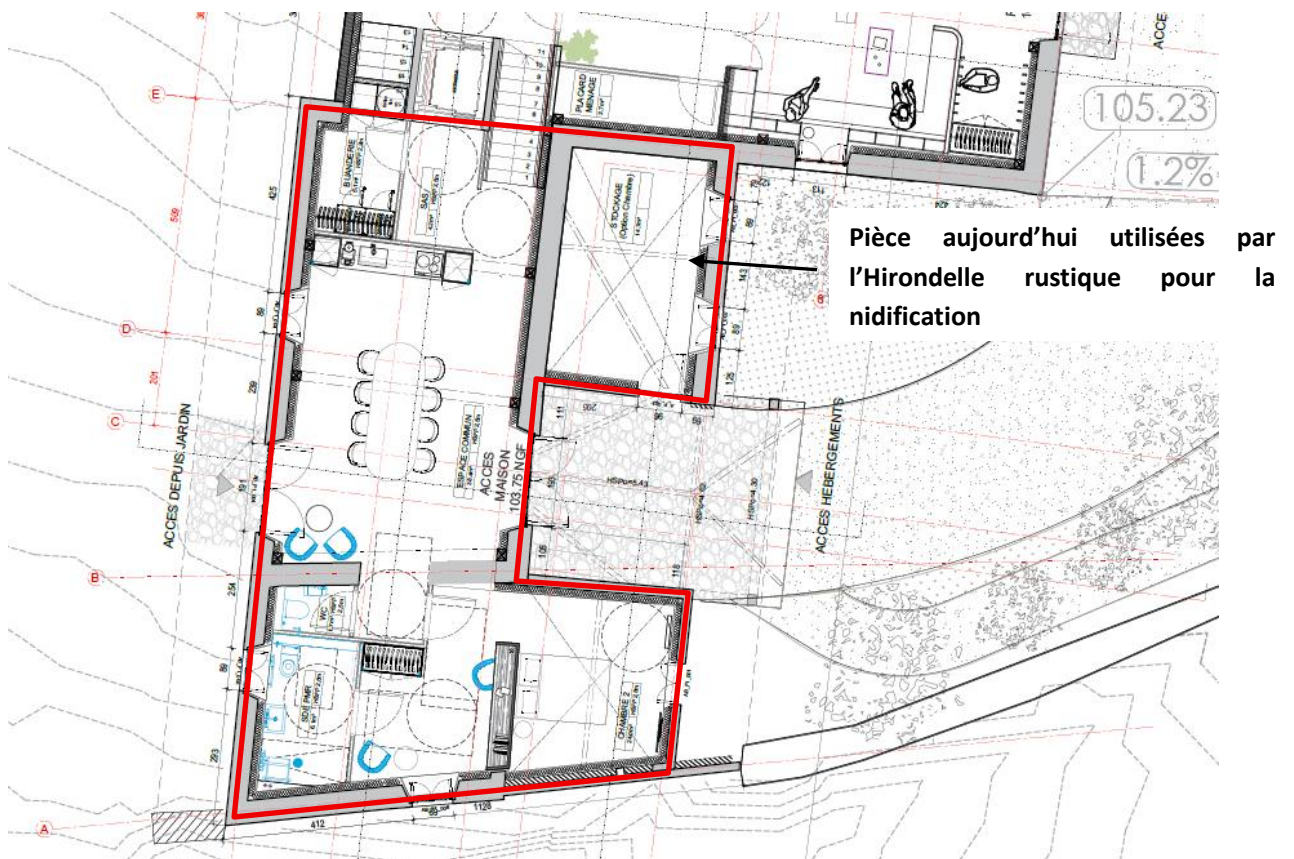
Plan du rez-de-chaussée au niveau de l'étable
